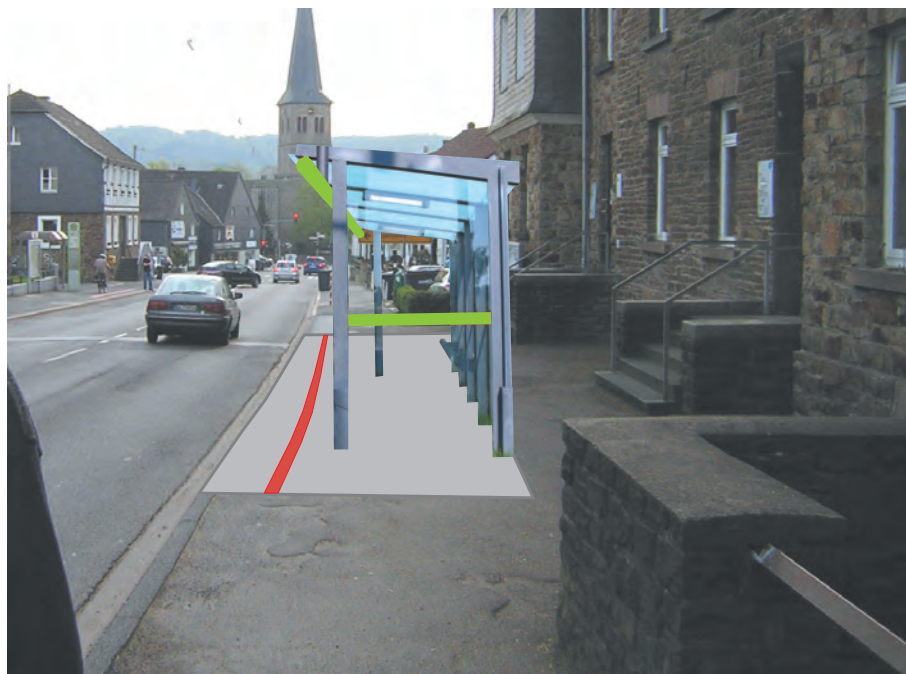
Errichtung Haltestelle Rathaus, Fahrtrichtung Bahnhof
